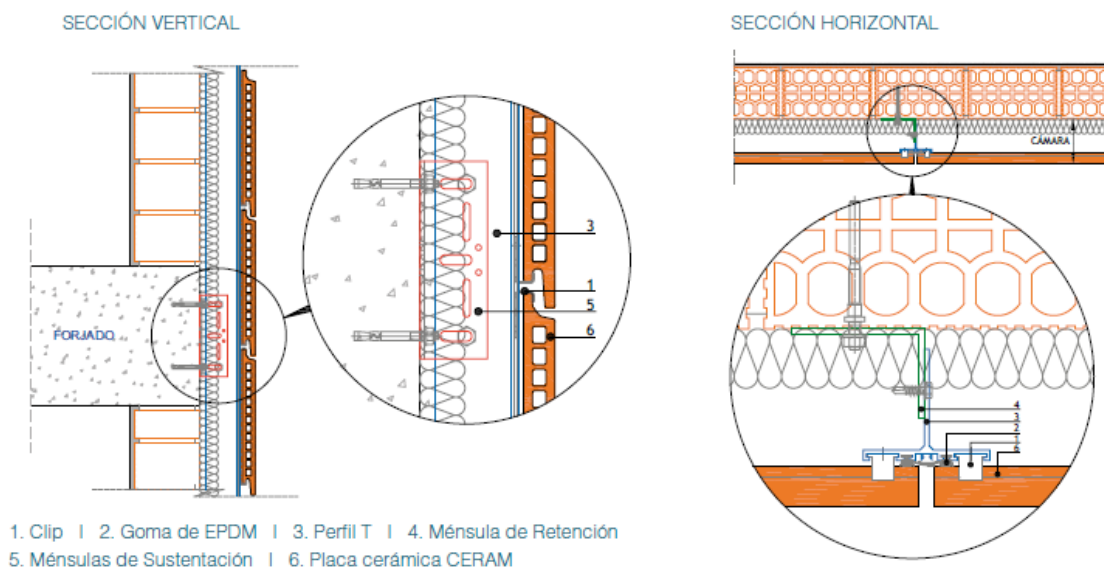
Detalles de la fachada – (Catalogo Faveton)
